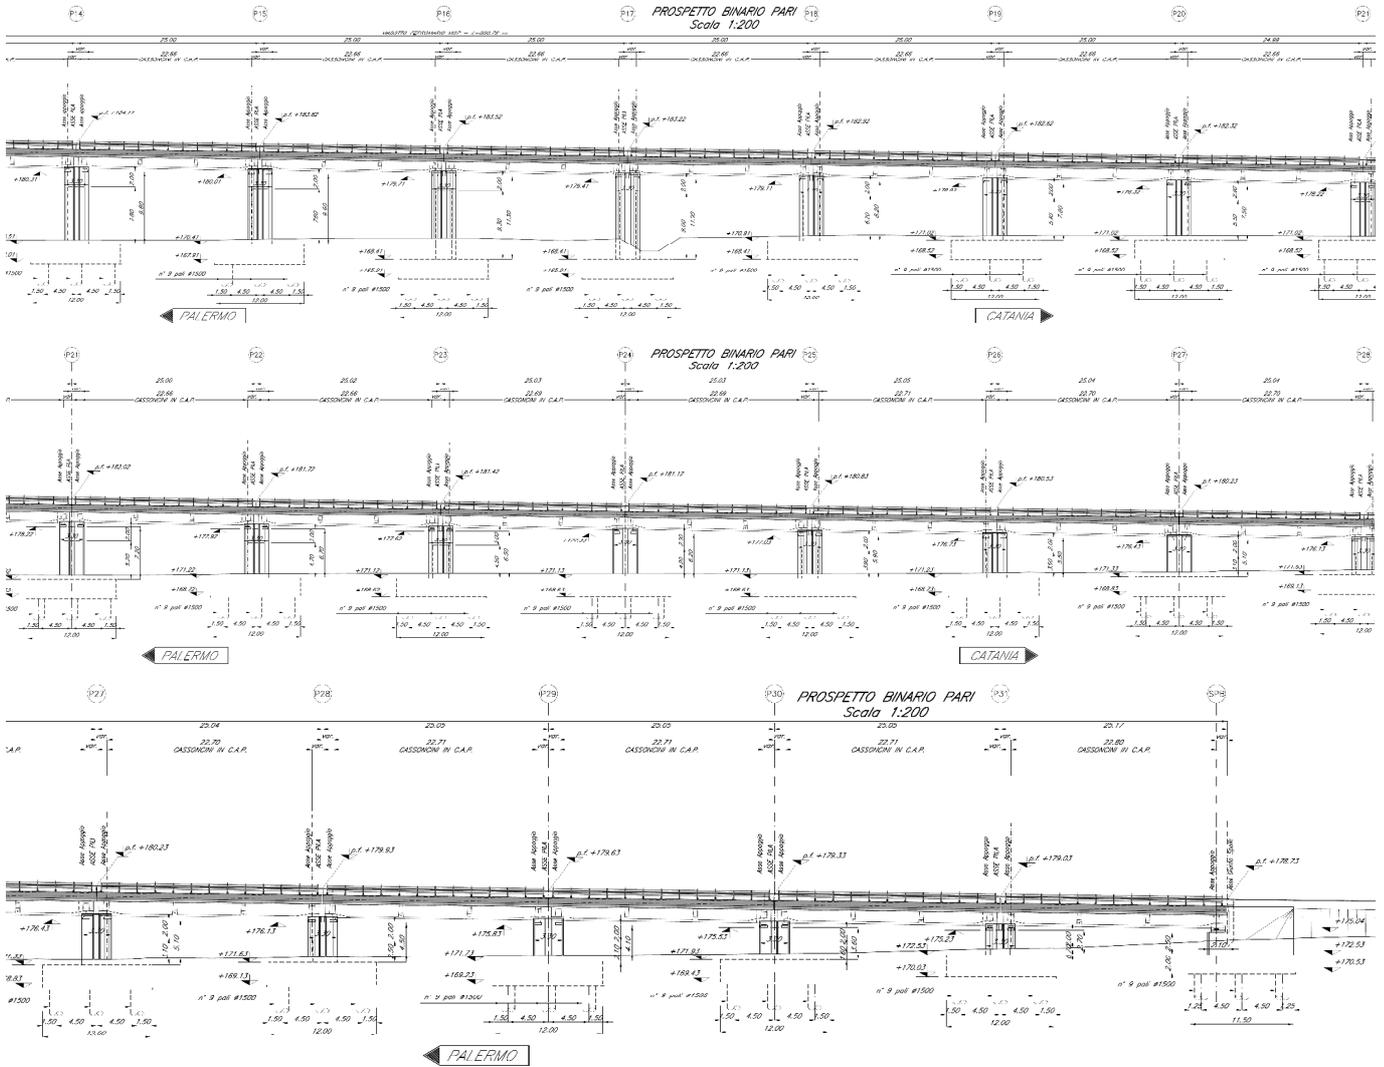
Viadotto VI15: sezione trasversale e prospetto binario pari
